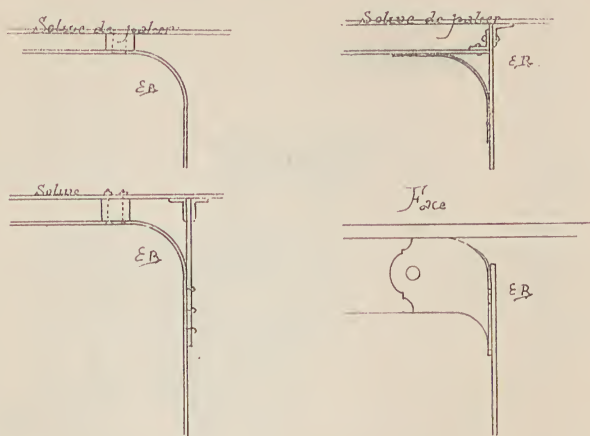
, 905, 906, 907. — Assemblages de limons sur paliers.
